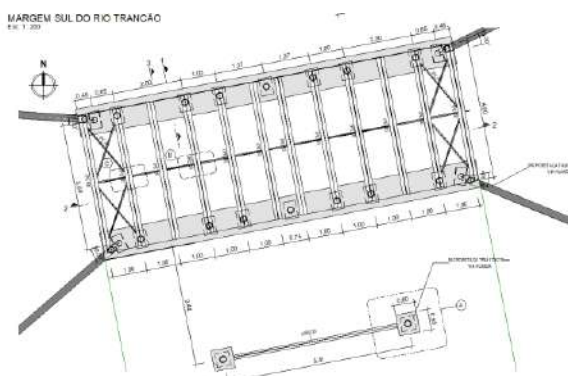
Estrutura do encontro da ponte militar provisória a instalar sobre o rio Trancão.
